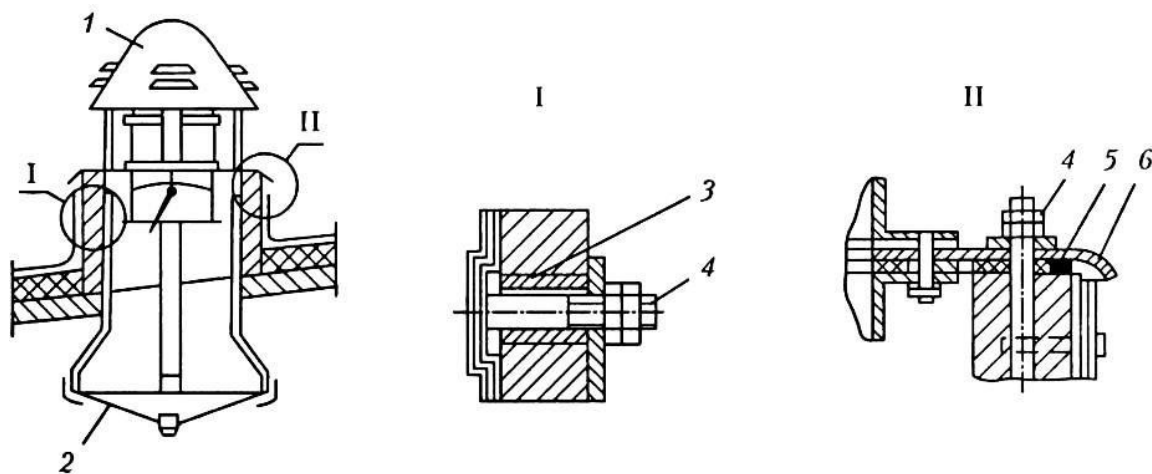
Установка крышного вентилятора на железобетонном стакане:
